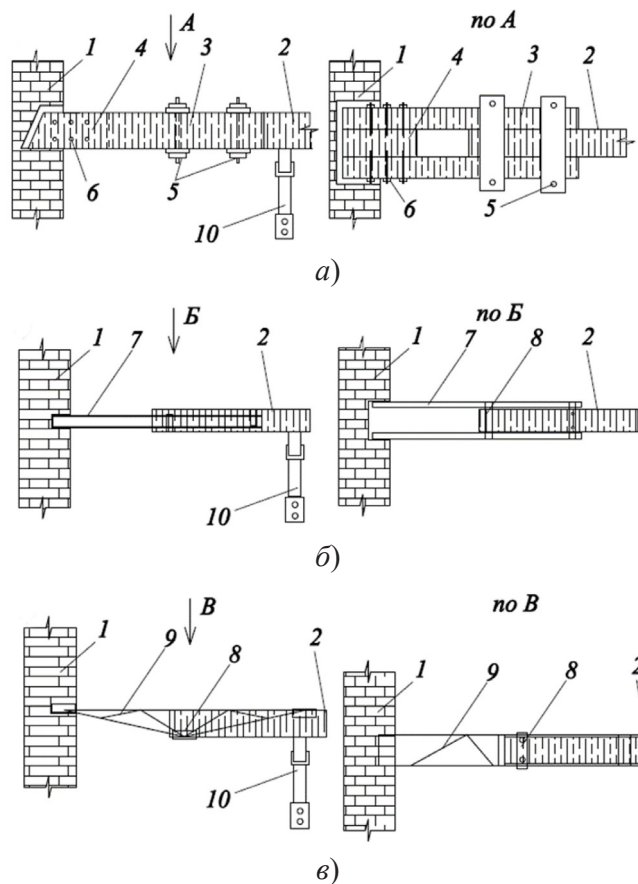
Усиление концов балок у опор протезами: а – из деревянных накладок; б – из стальных профилей; в – стальными прутковыми; 1 – стена; 2 – усиливаемая балка; 3 – боковая накладка; 4 – вкладыш; 5 – стяжной болт; 6 – гвозди; 7 – швеллер № 10–16; 8 – полоса; 9 – протез из арматуры  $\varnothing 16$  мм; 10 – временная стойка
